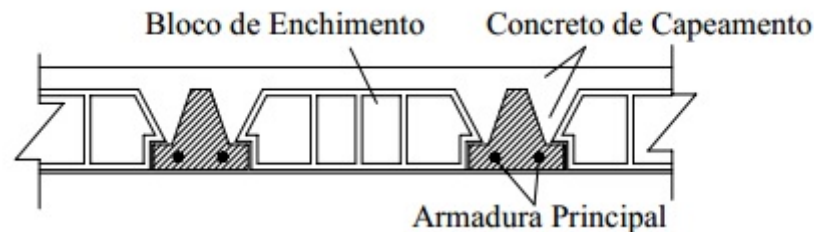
Laje Nervurada Pré-Moldada Tipo Trilho ou Volterrana. (Projeto e Construção de Lajes Nervuradas de Concreto Armado. São Carlos, 2005. DA SILVA, Marcos Alberto Ferreira)
